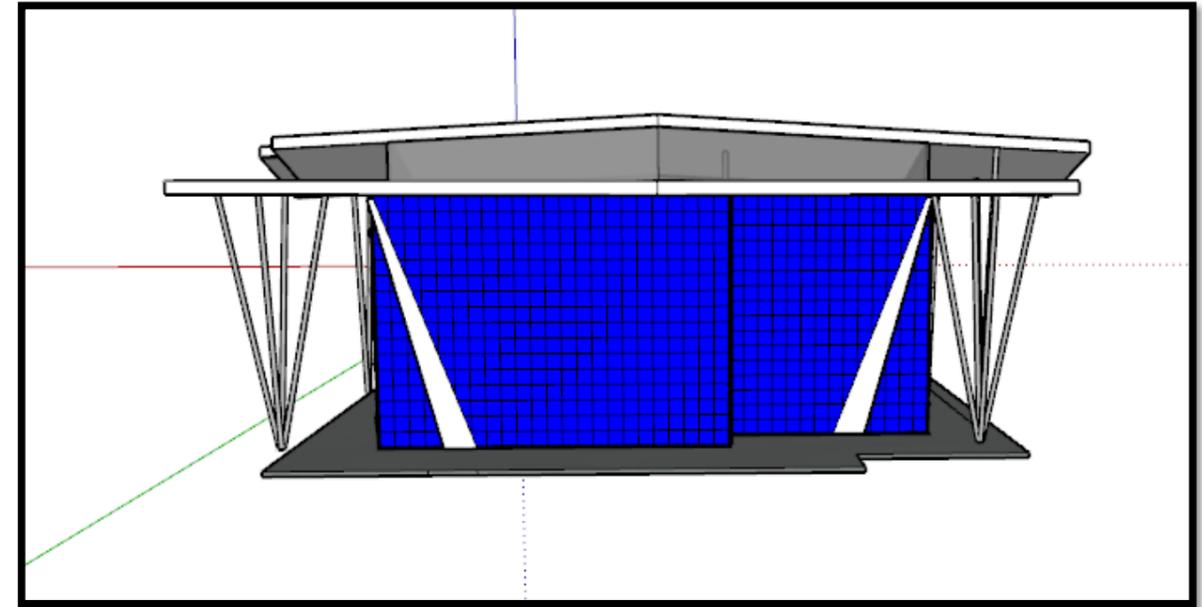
Mascara de sombra del lado norte de la terminal. Fuente: Autores.
